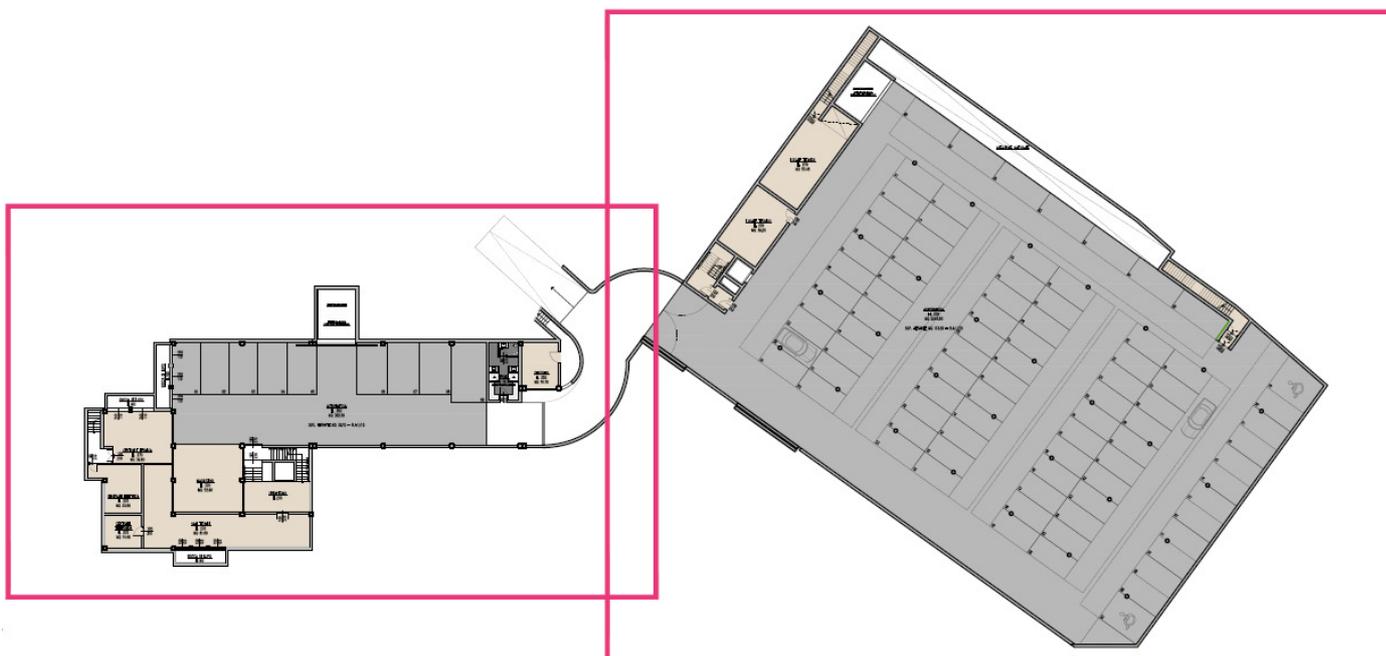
estratto Planimetria di progetto A4.02 piano terra
